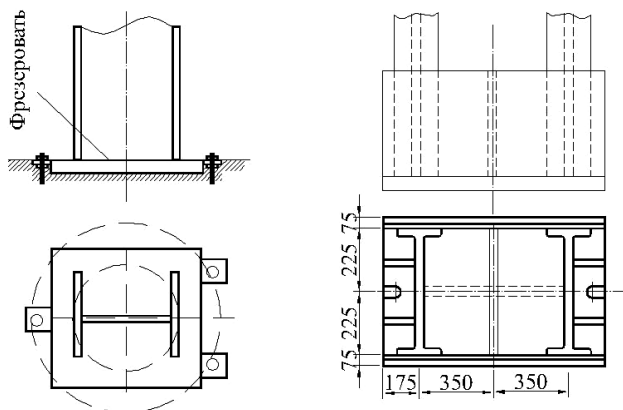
Базы центрального сжатия колонн: а – с фрезерованным торцом; б – с распределительной конструкцией
